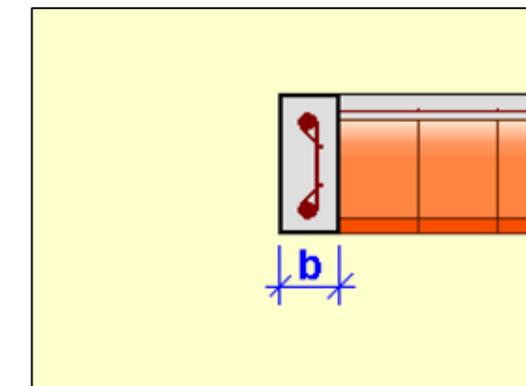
Sección tipo zuncho de borde. Fuente: CYPE
